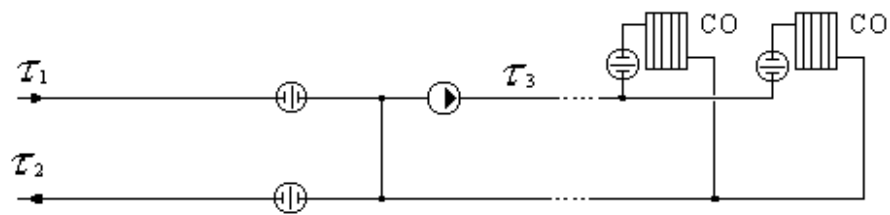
Схема ЦТП (ИТП) с насосом смешения на подающем трубопроводе
